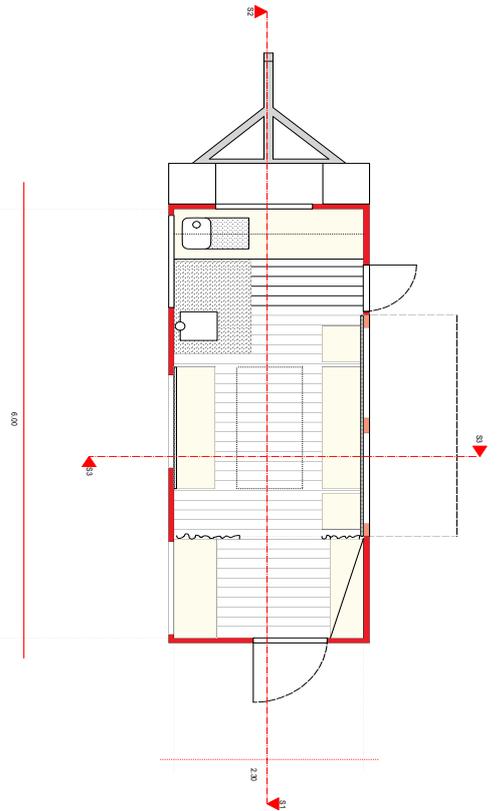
„Basis Grundriss“, M.1:200,
